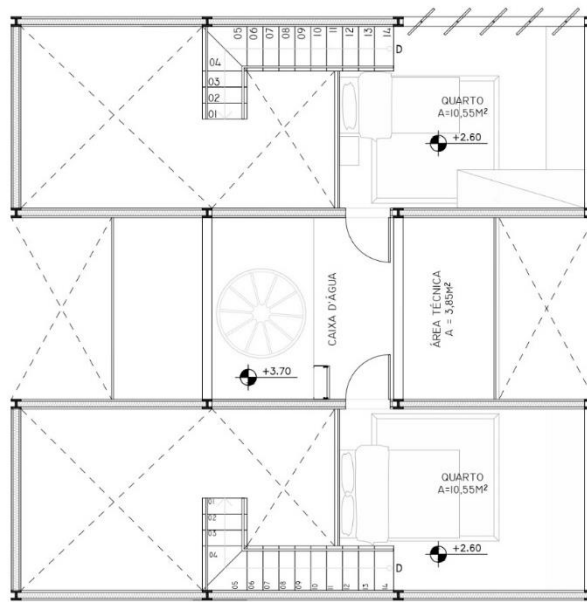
Planta Baixa da tipologia 01 – térreo. Fonte: Acervo do Autor.
